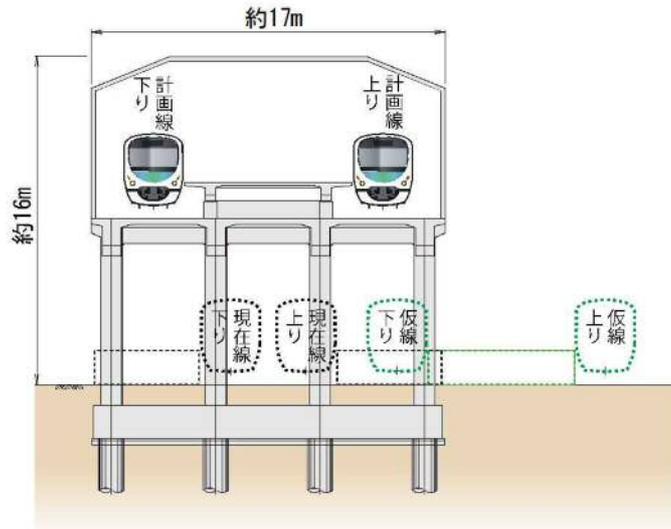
(3) 駅部標準断面図 (E-E' 断面：武蔵関駅)
